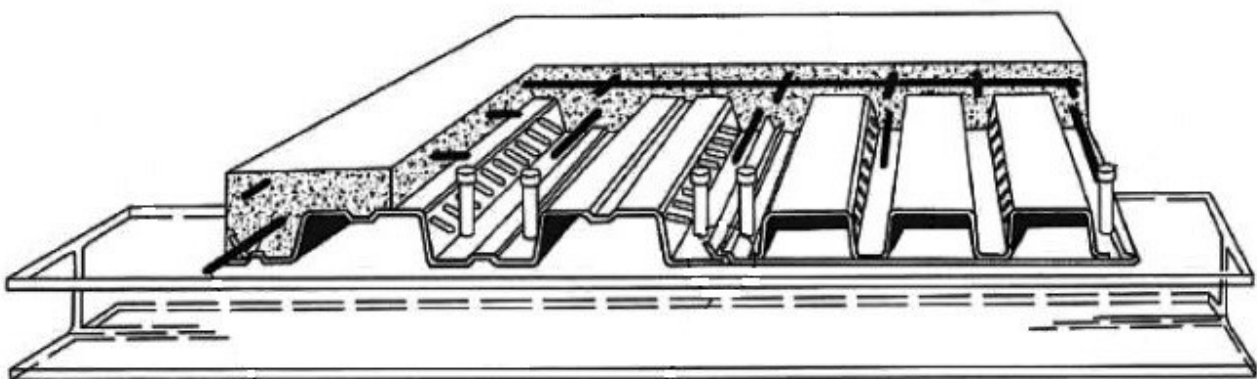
Сталежелезобетонная плита с профилированным настилом
